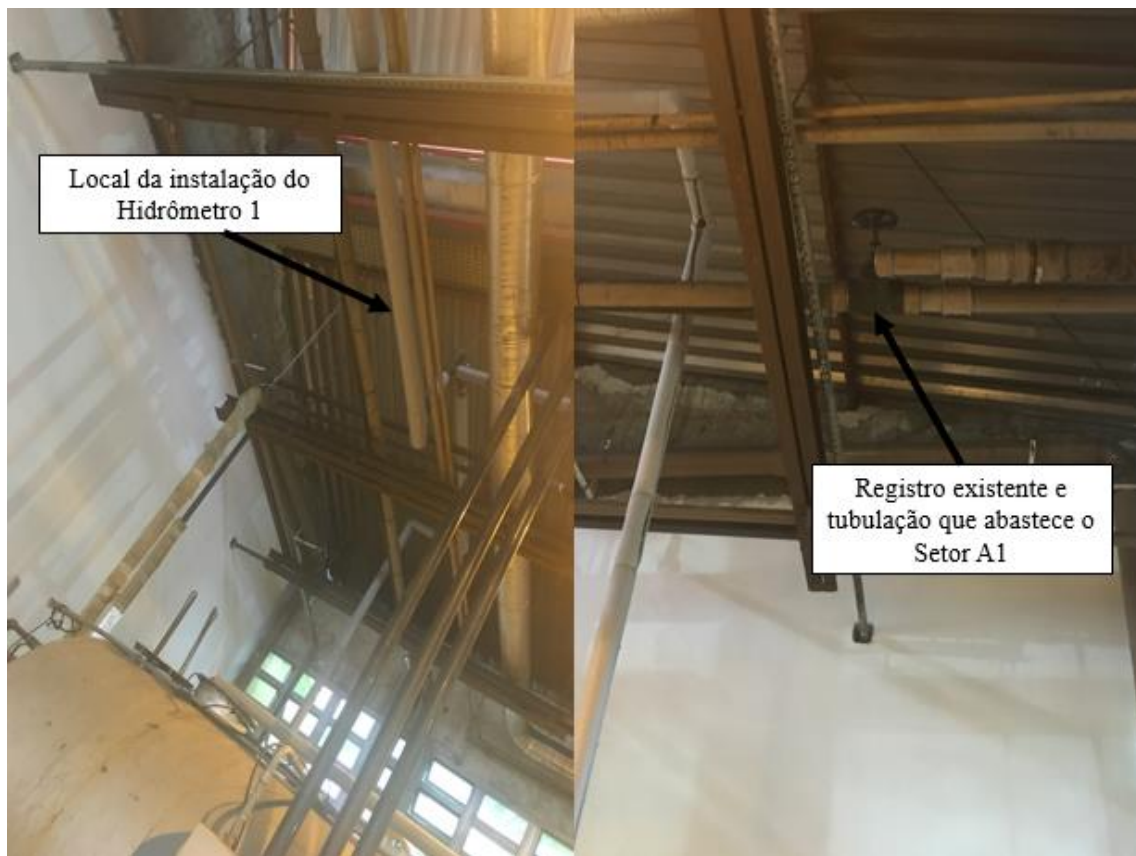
Localização do registro existente e da instalação dos Hidrômetro 1.
